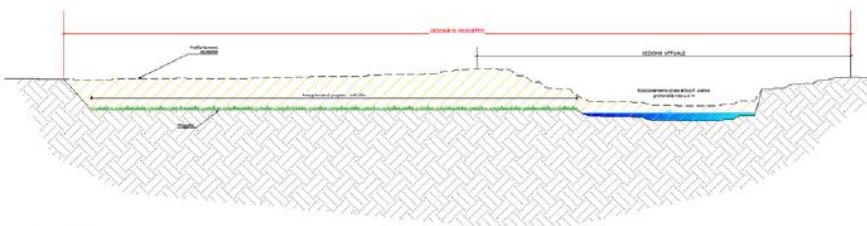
Sezioni tipo risezionamento in comune di Molina Aterno.
